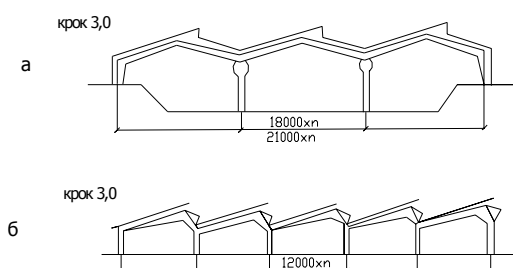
Конструктивные схемы многопролетных зданий:
